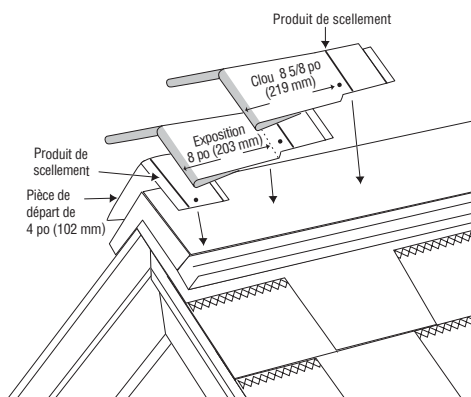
Recouvrement d'arête et de faîte avec Mountain Ridge.
